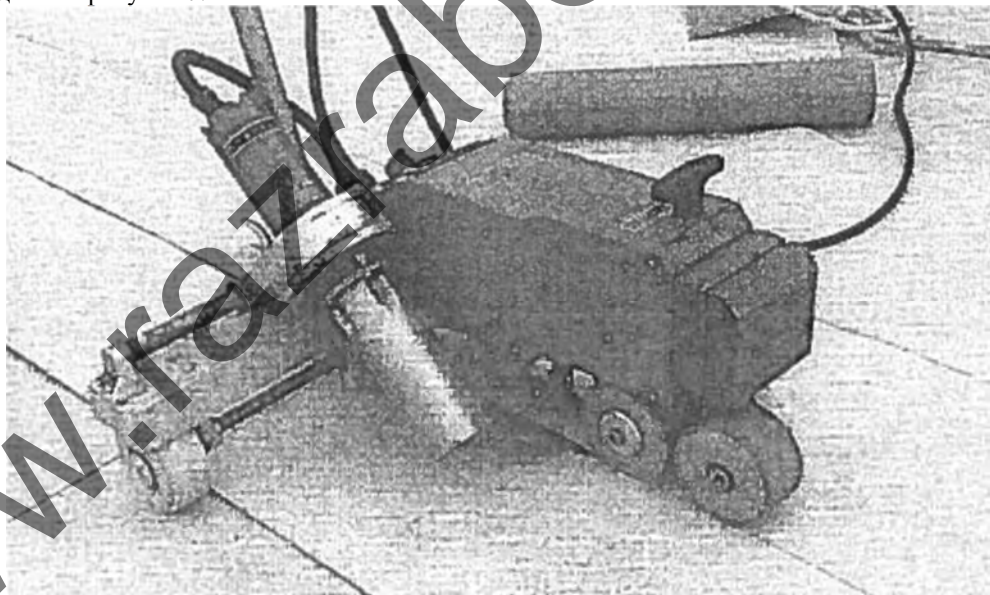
Схема сварки и уплотнения швов ПВХ-мембраны с помощью автоматического сварочного аппарата
